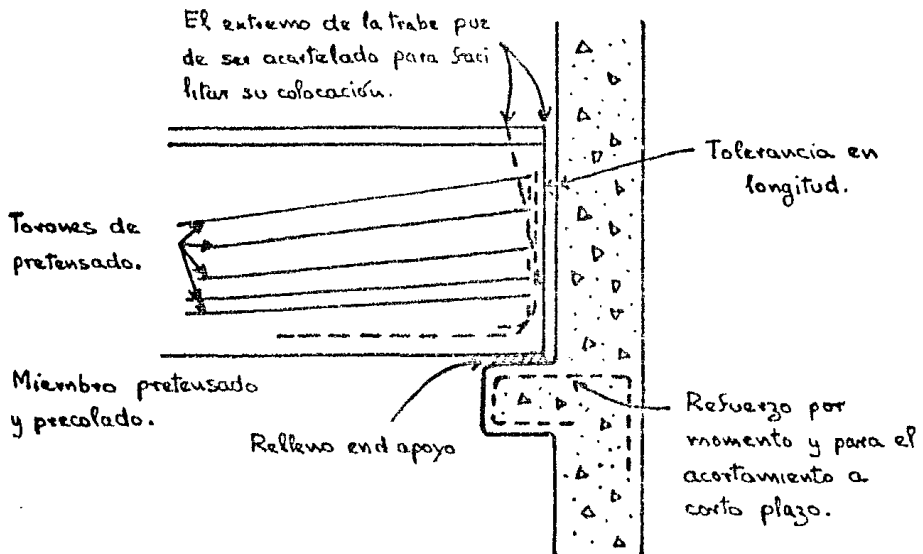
Detalle típico de apoyo; losa o trabe sobre un
